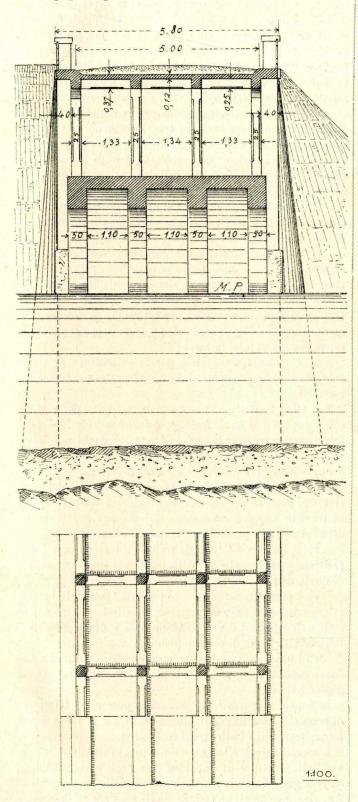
Sezione schematica del Ponte, porzione di pianta vista dal basso in alto e sezione orizzontale al piano dei pilastrini.
